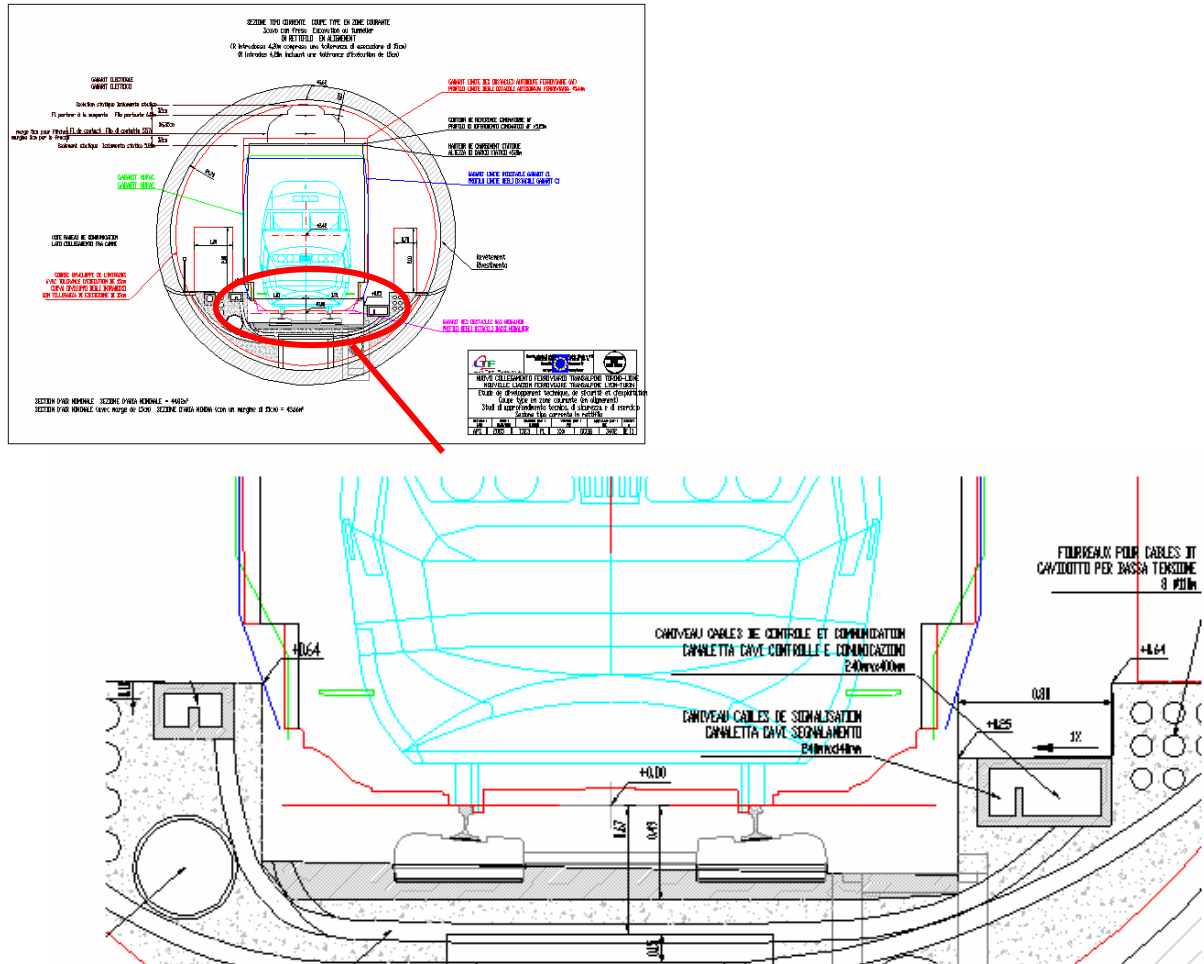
Spaccato tipo in tunnel. Zoom livello basso
